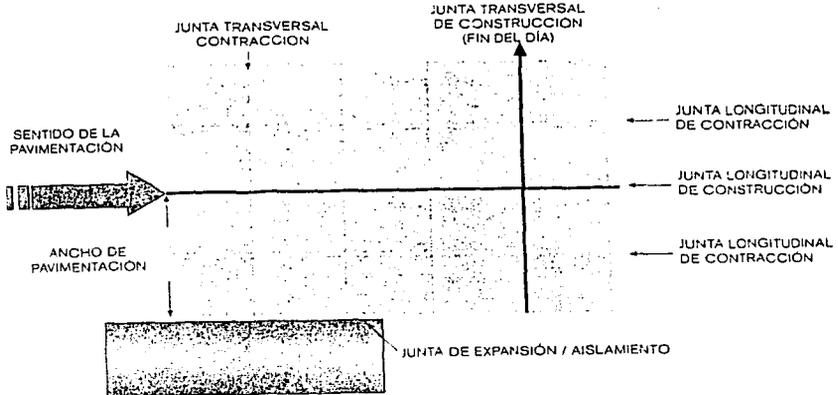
CROQUIS DE LOS TIPOS DE JUNTAS EN UN PAVIMENTO DE CONCRETO.
